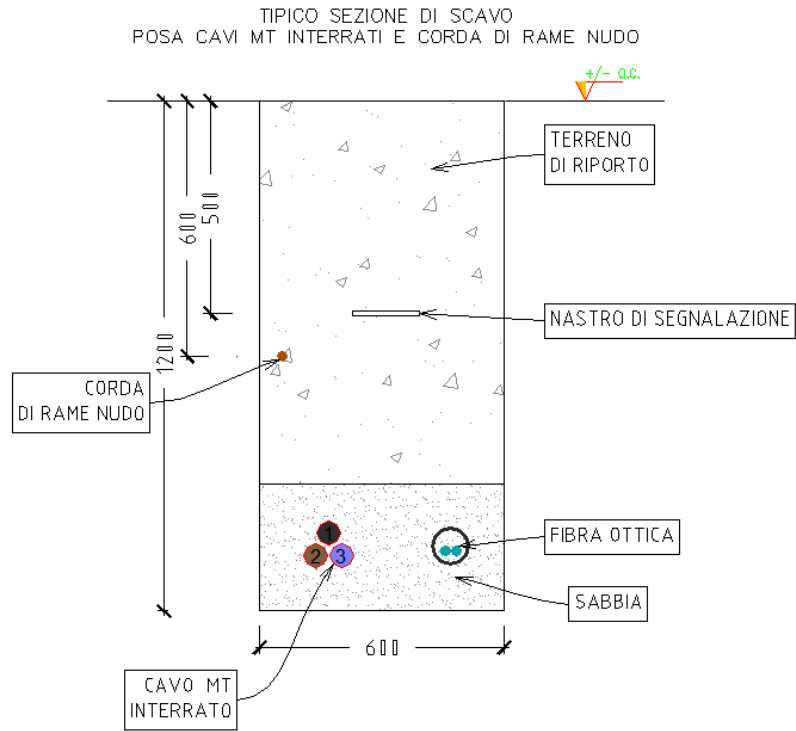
Sezione tipo posa cavo MT con n° 1 linea
